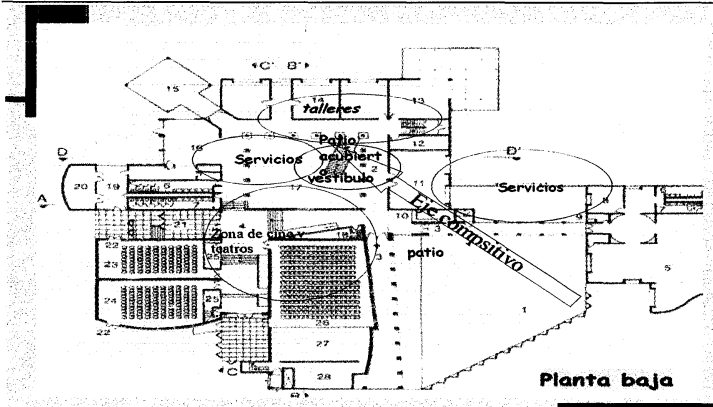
La planta arquitectónica muestra un eje compositivo diagonal que parte de la plaza exterior atraviesa el patio central cubierto y remata con el volumen de la terraza techada.
